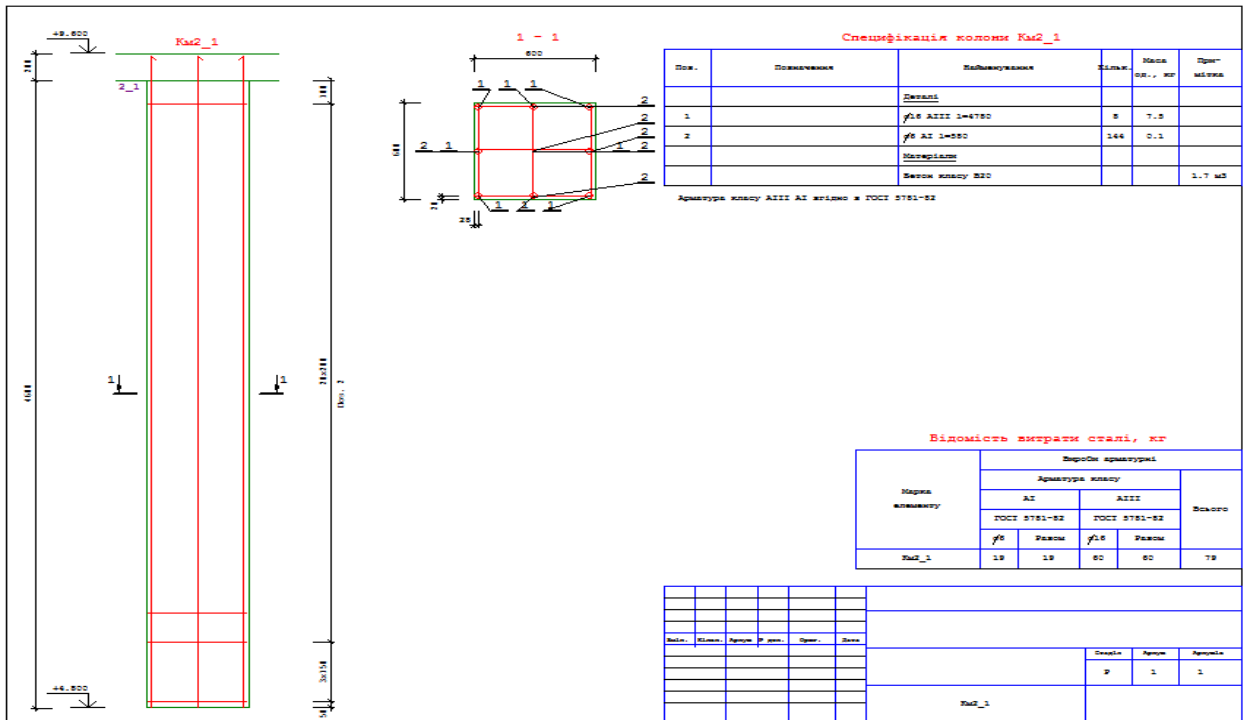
Варіант будівлі з плитним перекриттям. Колона К2-1. Креслення робочого проекту.
